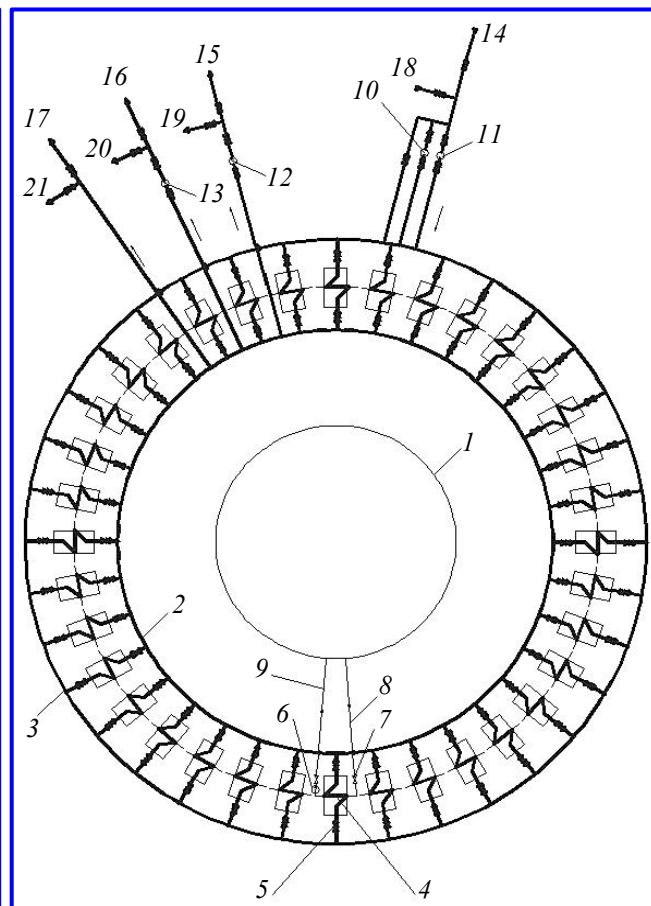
Схема отвода тепла из хранилища; 1 – хранилище; 2, 3 – кольцевые трубопроводы подвода и отвода воды; 4 – теплообменник (36 шт.); 5 – задвижка; 6 – вентилятор; 7 – вентиль; 8, 9 – трубопроводы для газа; 10 – 13 – насосы Д1600-90а; 14 – 17 – ответвление к теплосети; 18 – 21 – ответвление к разомкнутой системе водоснабжения
